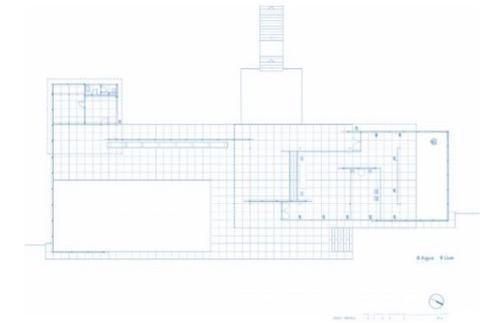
Planta arquitectónicas del pabellón de Barcelona.
